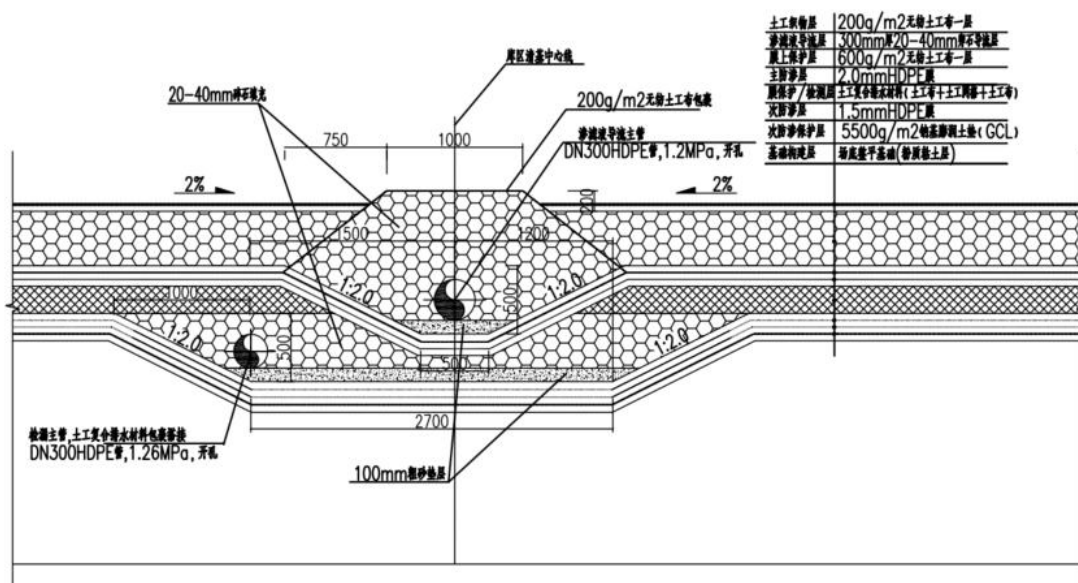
渗滤液导流盲沟断面及渗滤液导排系统断面图
